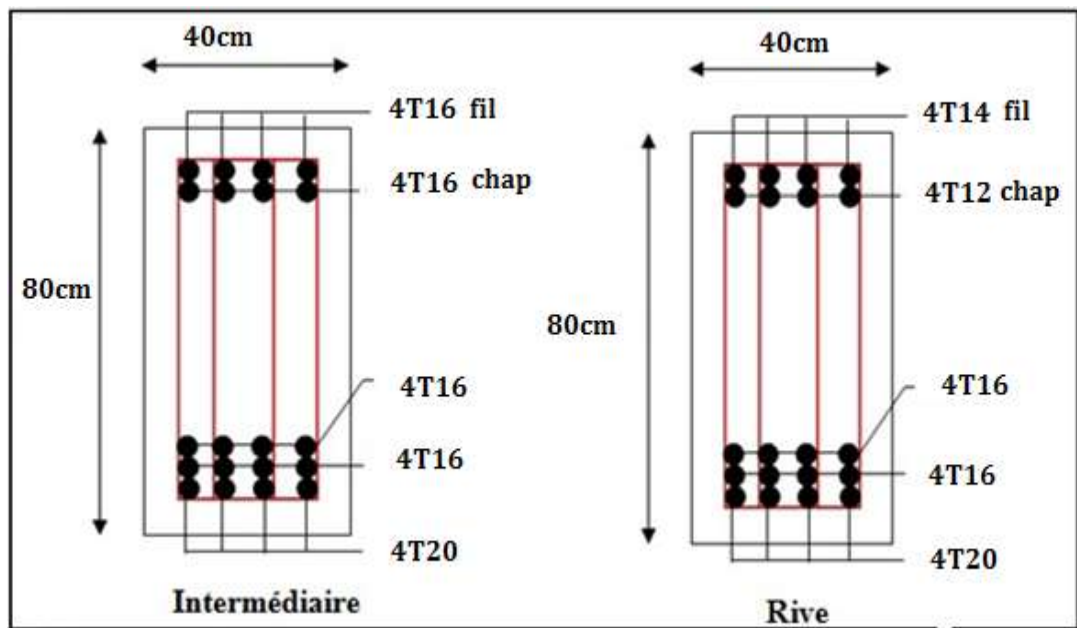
Ferrailage de la poutre de libage suivant le sens longitudinale.
